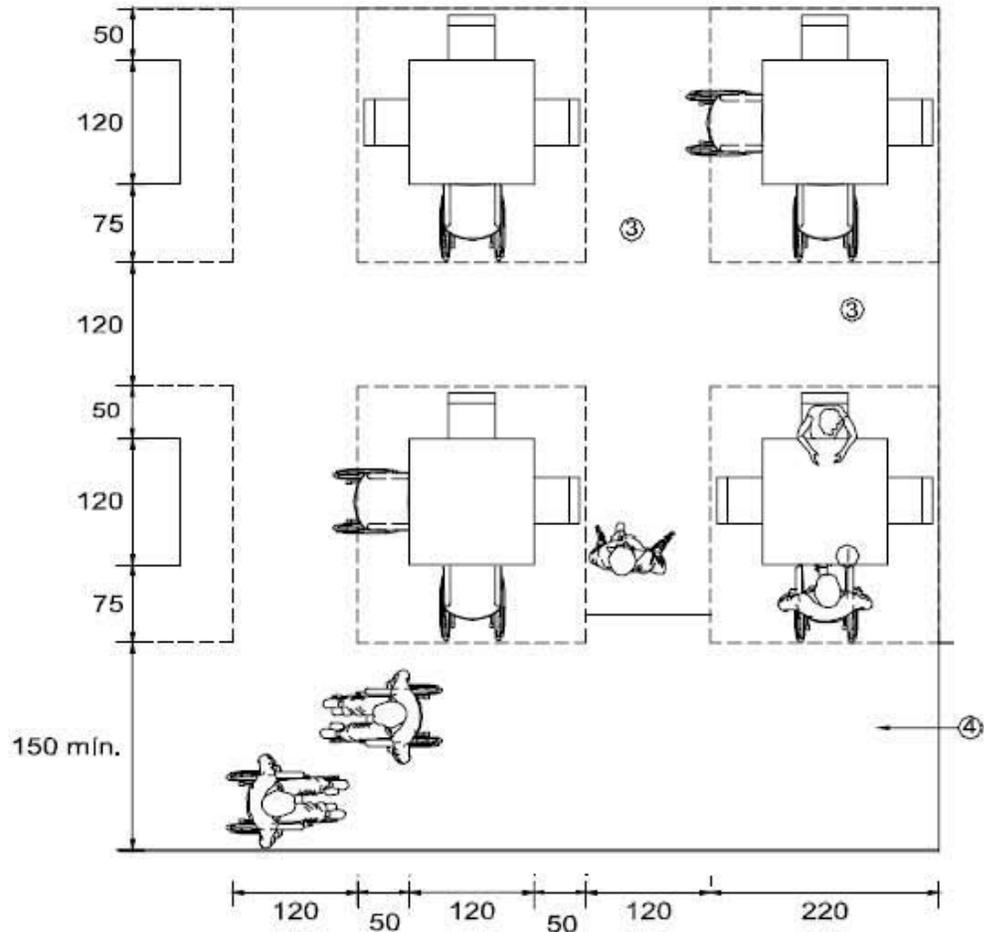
Detalle en planta de la dimensiones del área de comensales
